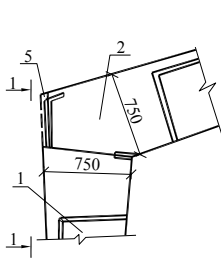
Конструкція з'єднання ригеля зі стояком піврами: 1-стояк; 2- ригель; 3- арматурні випуски; 4-закладна деталь; 5- цем. розчин
